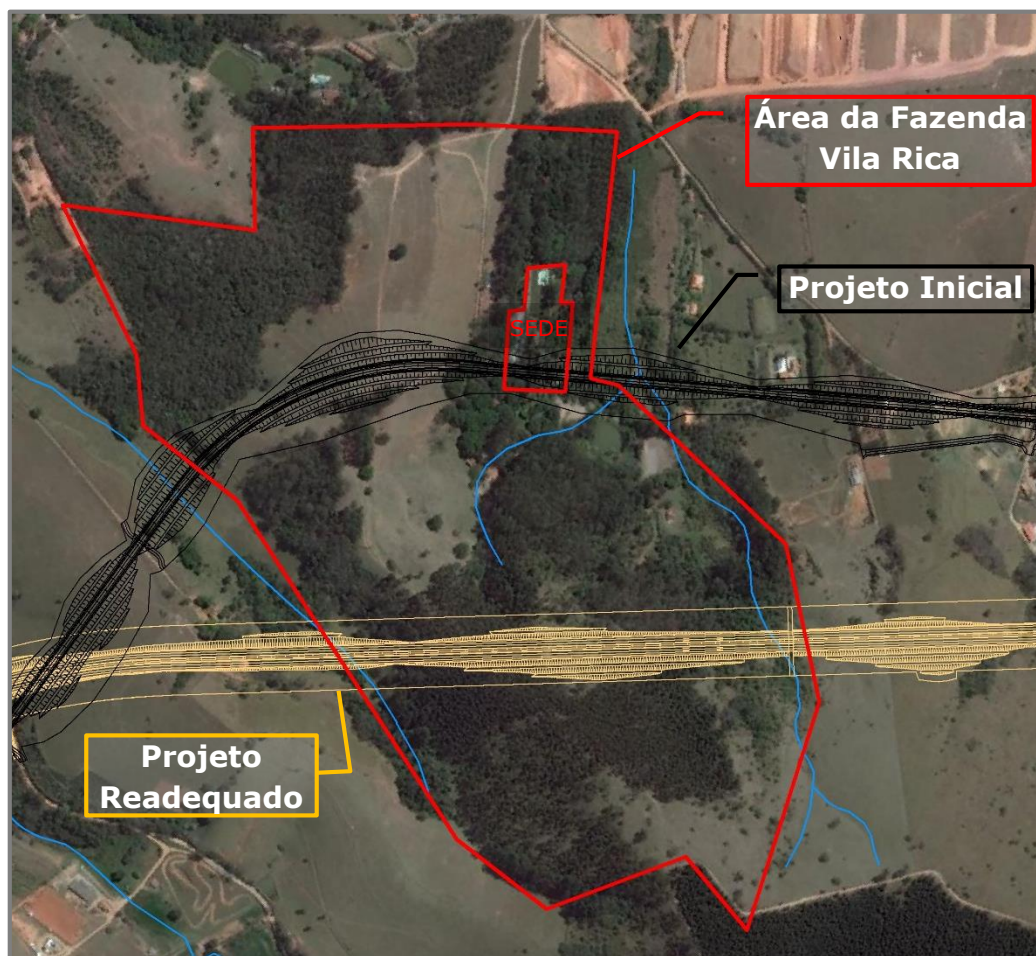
Detalhe do *Ponto 2* onde o traçado teve como alternativa desviar de quatro edificações.
